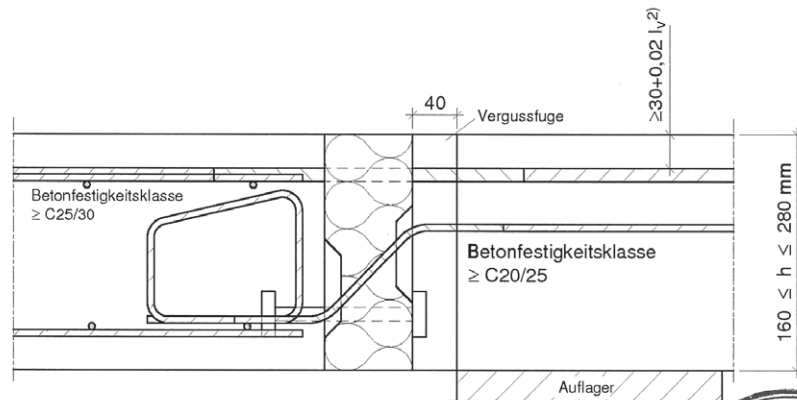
Beispiel Schöck Isokorb Typ RKX-239 in eingebautem Zustand mit Vergussfuge
